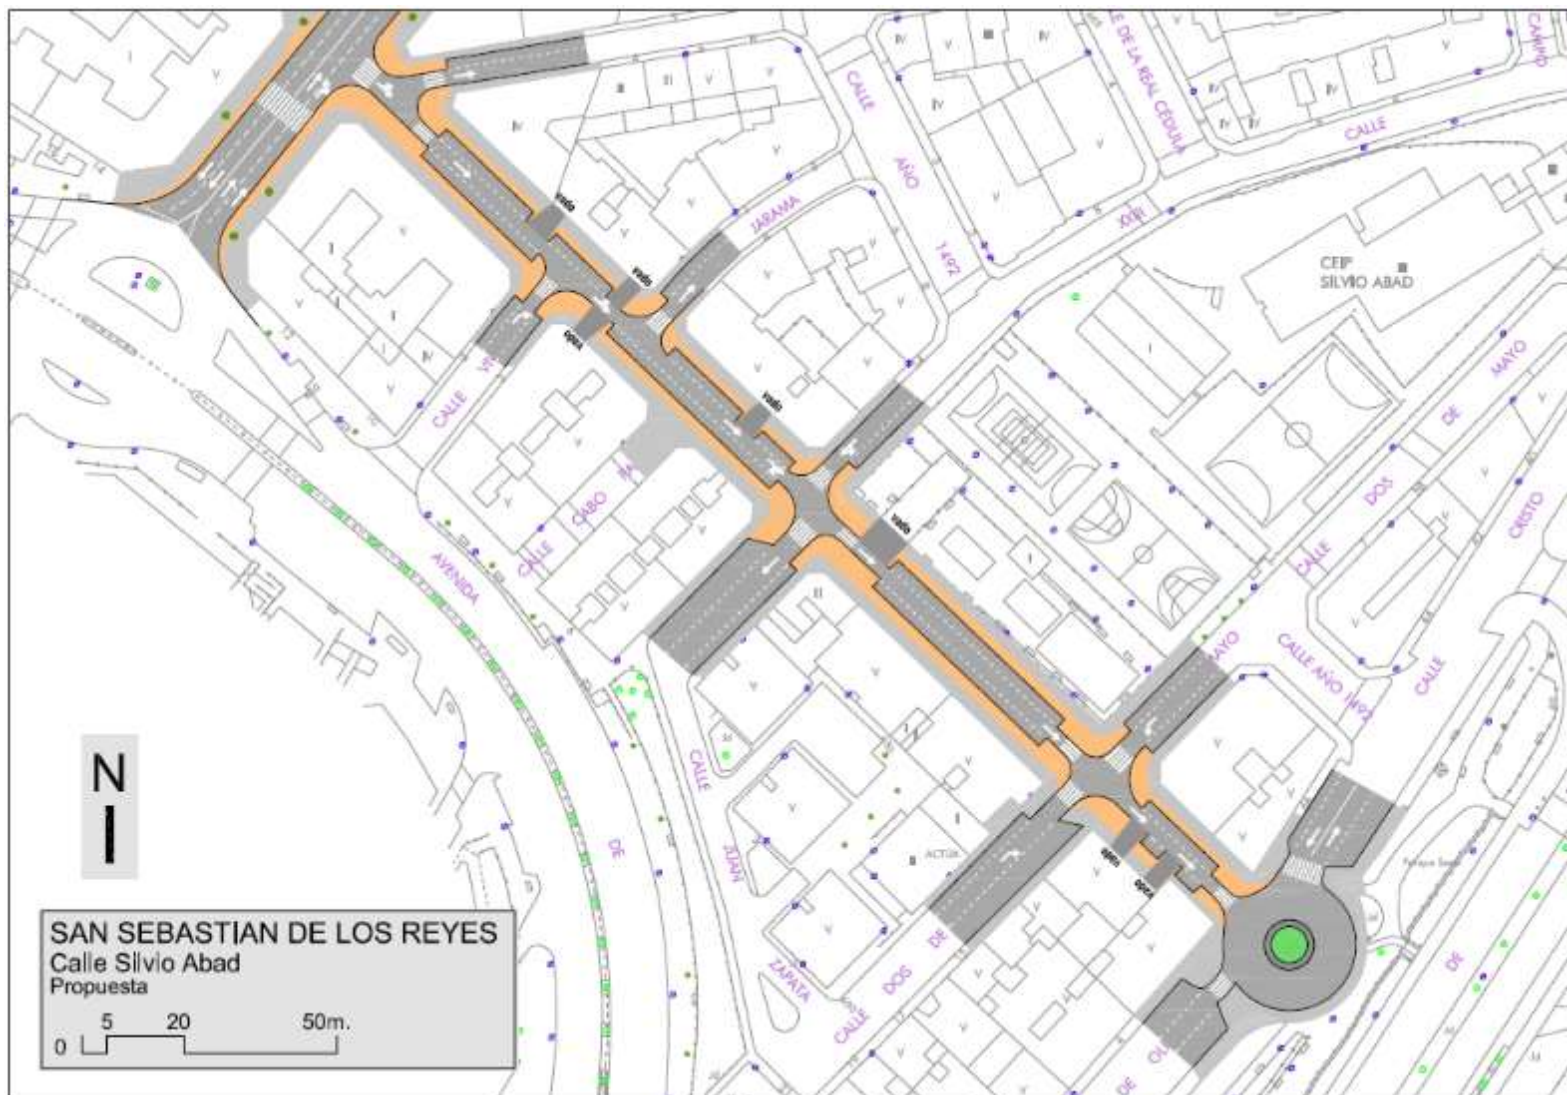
Planta propuesta para Calle Silvio Abad. Fuente: DOYMO.
